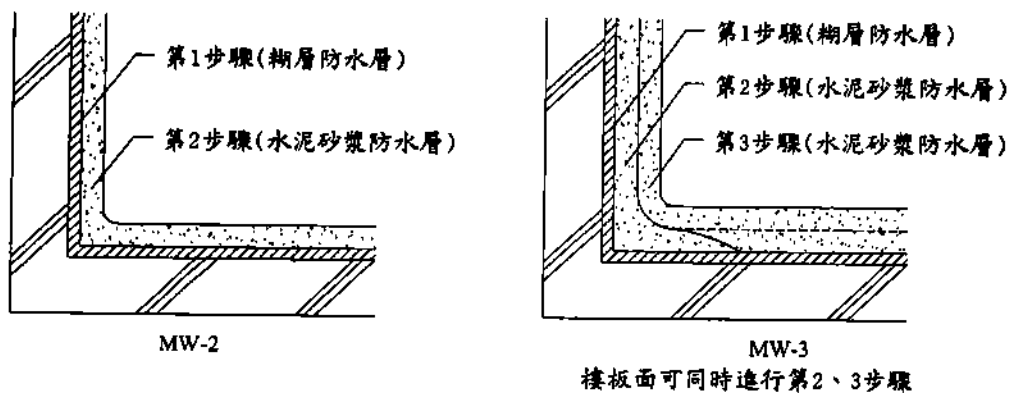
MW-2 與 MW-3 之施工規範圖
